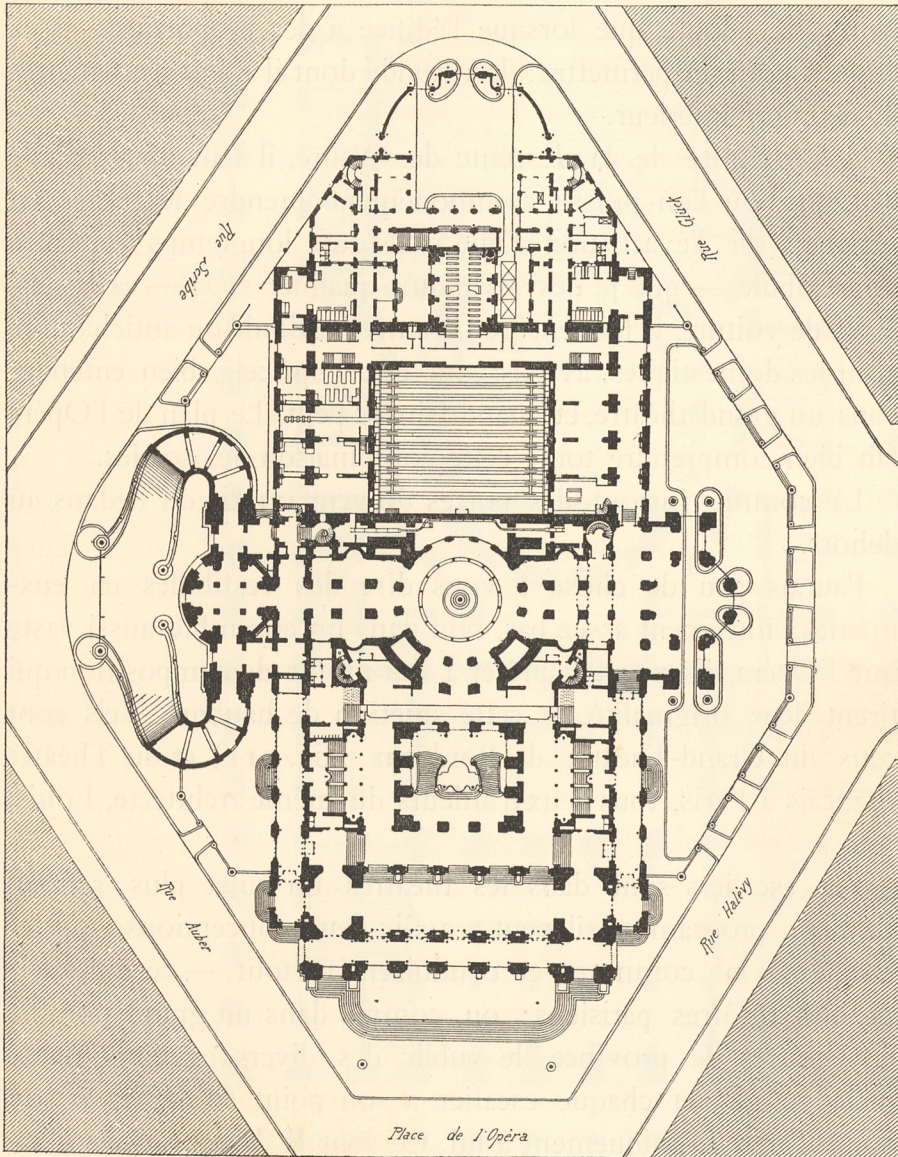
L'Opéra. Plan du rez-de-chaussée.
